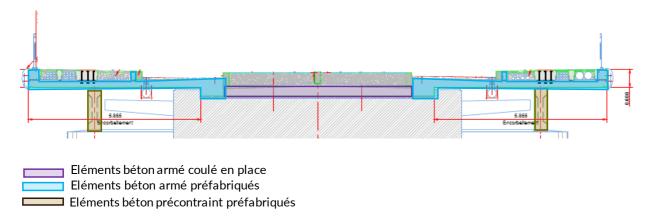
schéma d'implantation de la nouvelle dalle pour chaque ouvrage d'art
